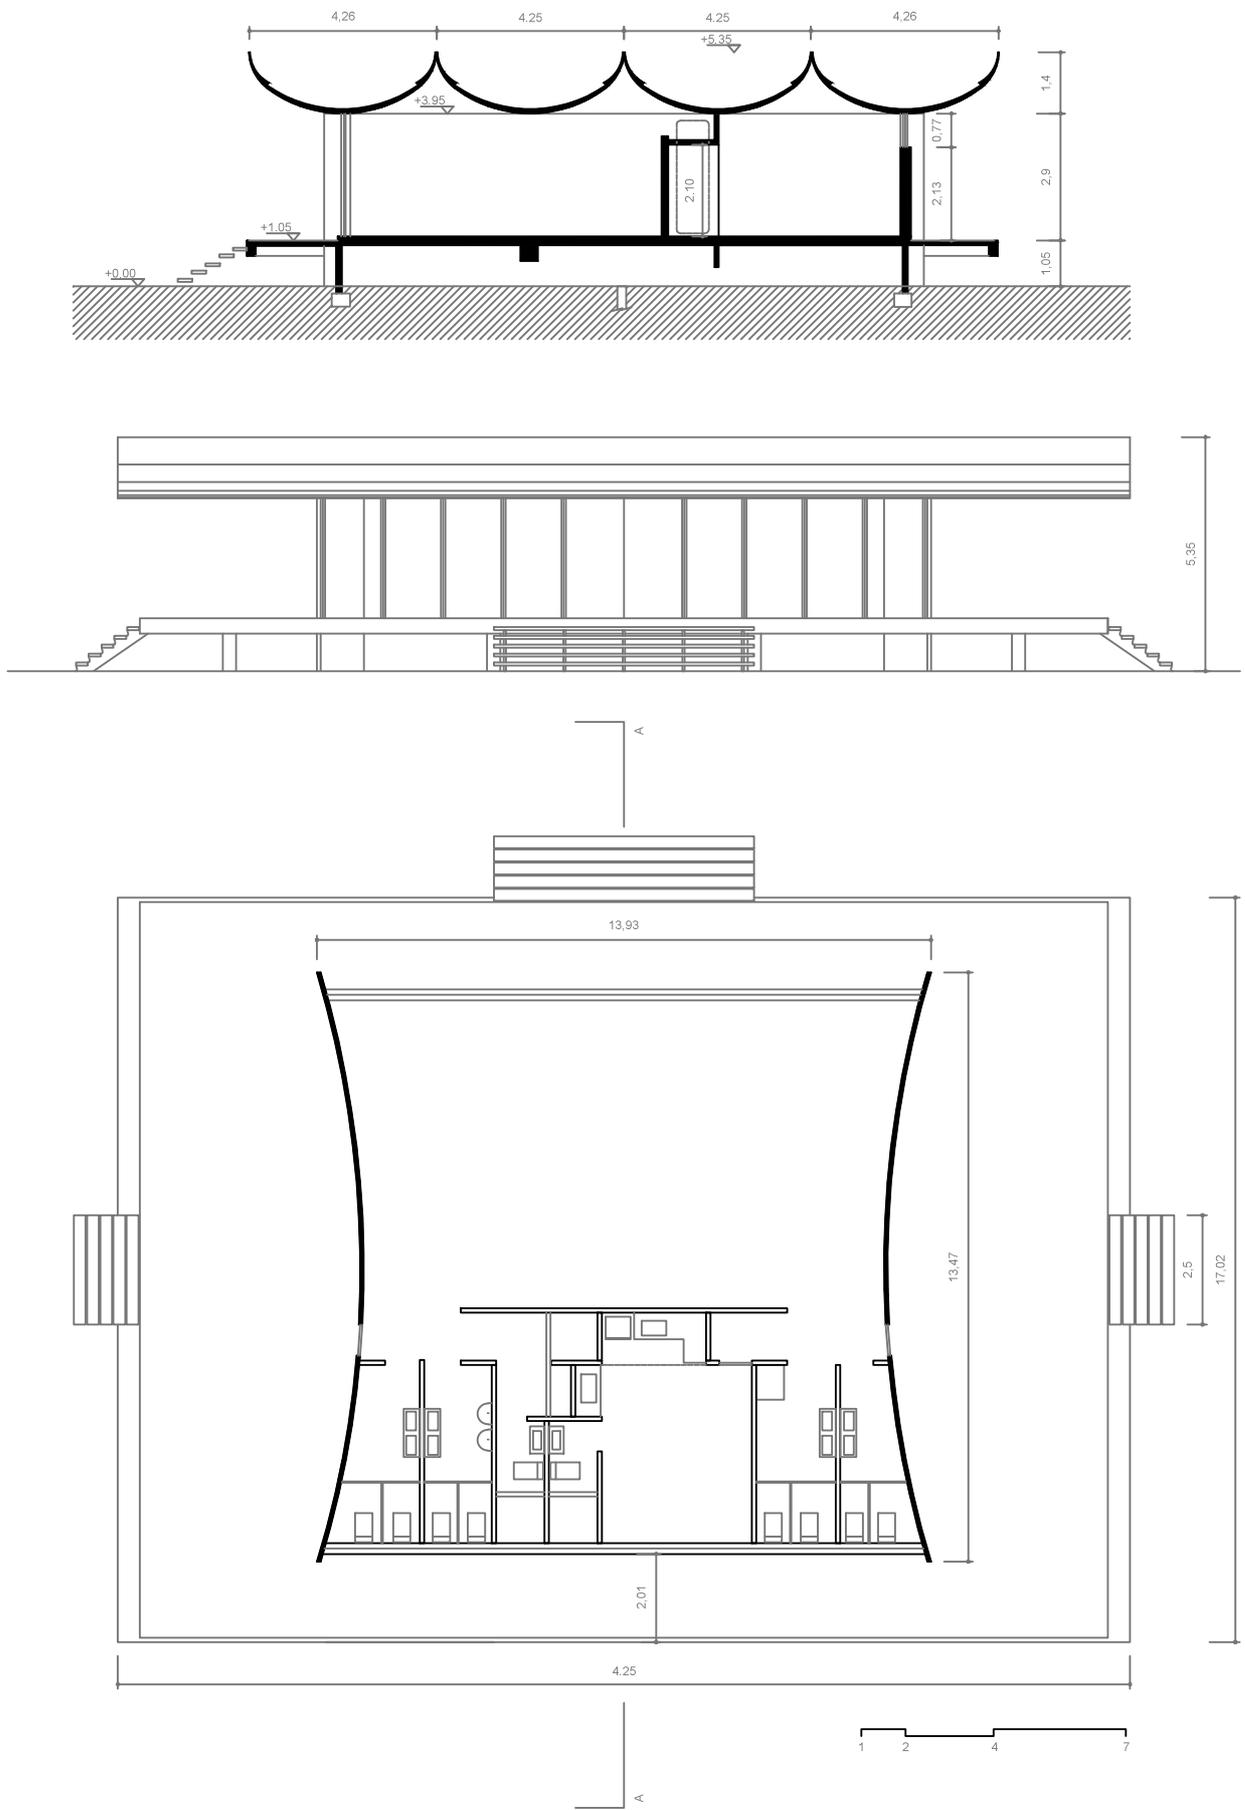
Planta, elevação e corte transversal do Pavilhão do Flamengo.
